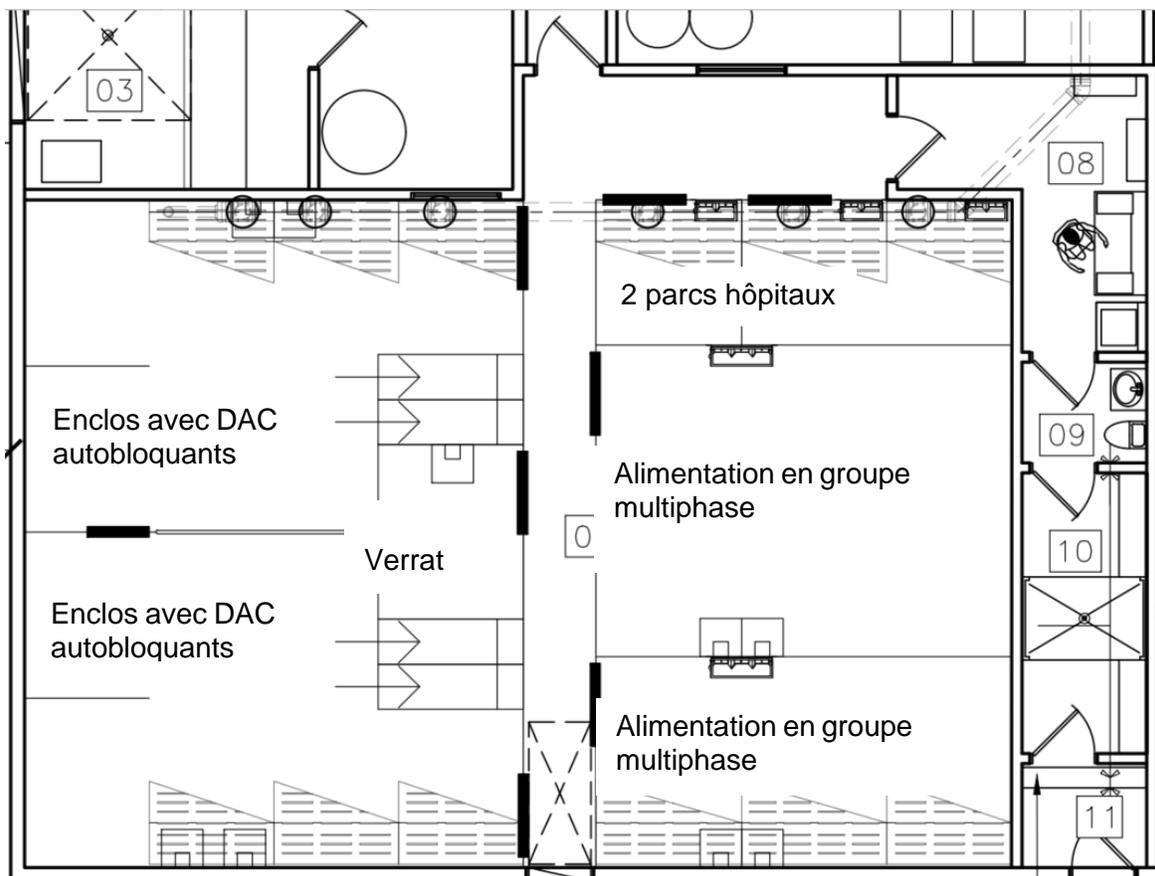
Plan de plancher de la quarantaine (47'-6'' x 32'-2'')
